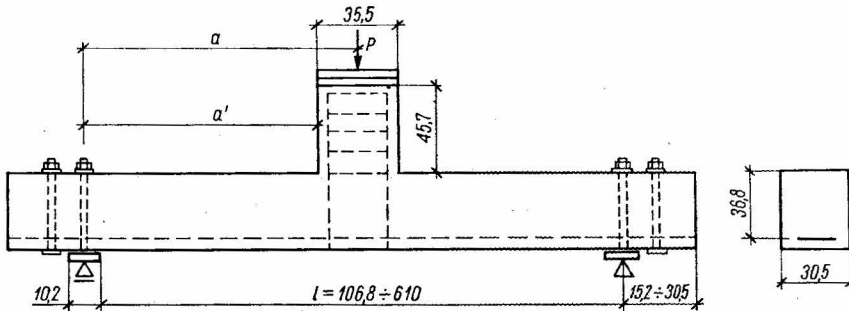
Structure d'une poutre dans les essais de MORROW et VIEST [62]
